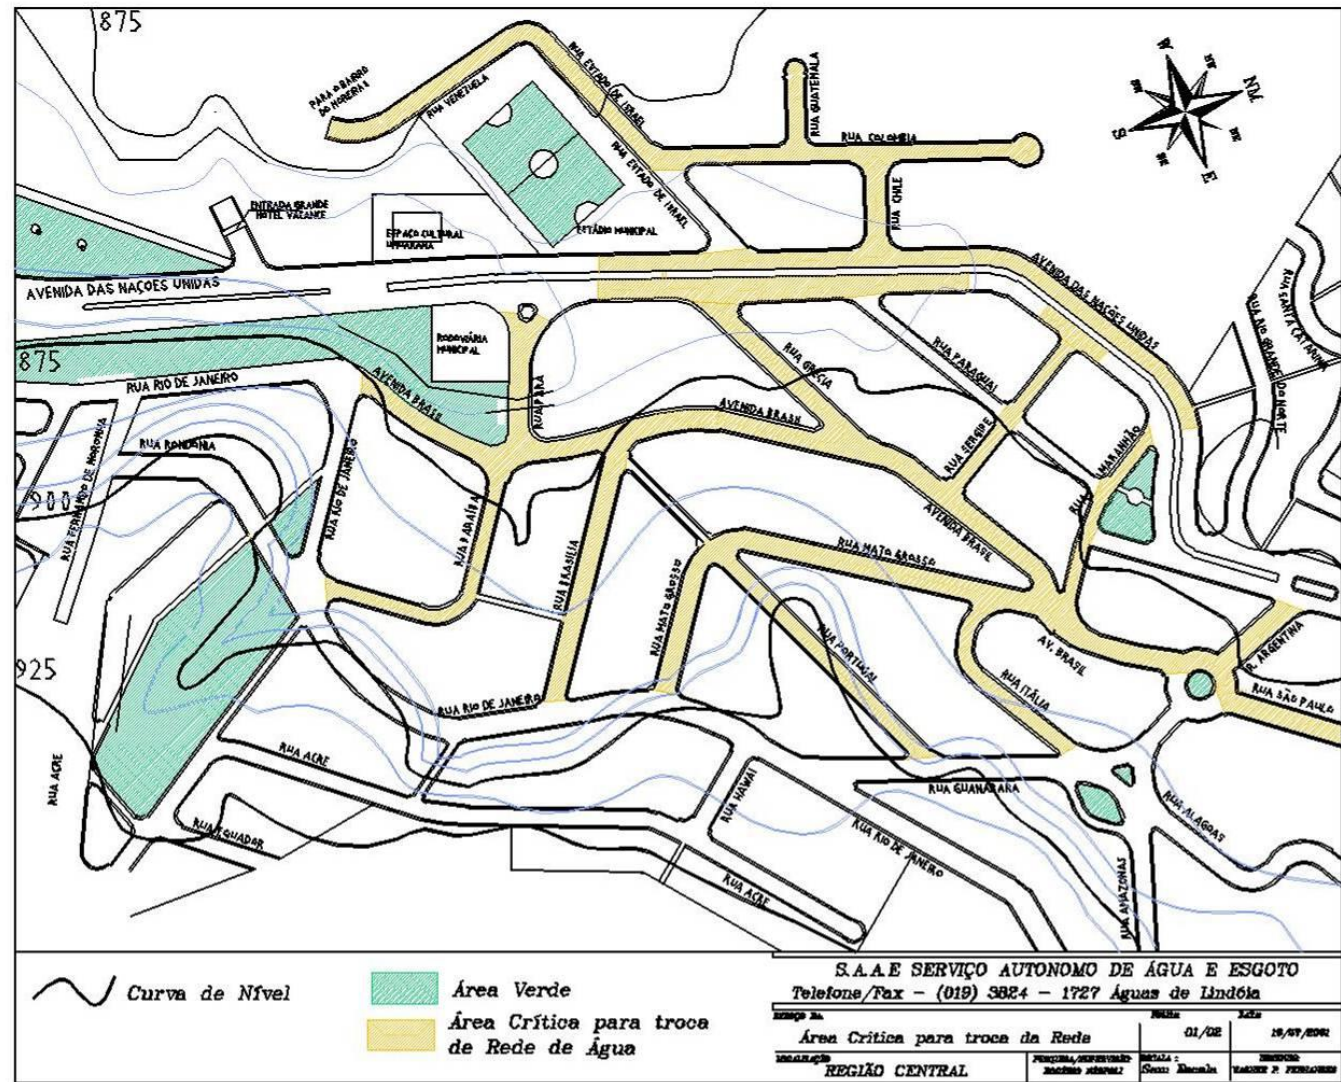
C: Planta das áreas críticas para substituição de tubulação da rede
